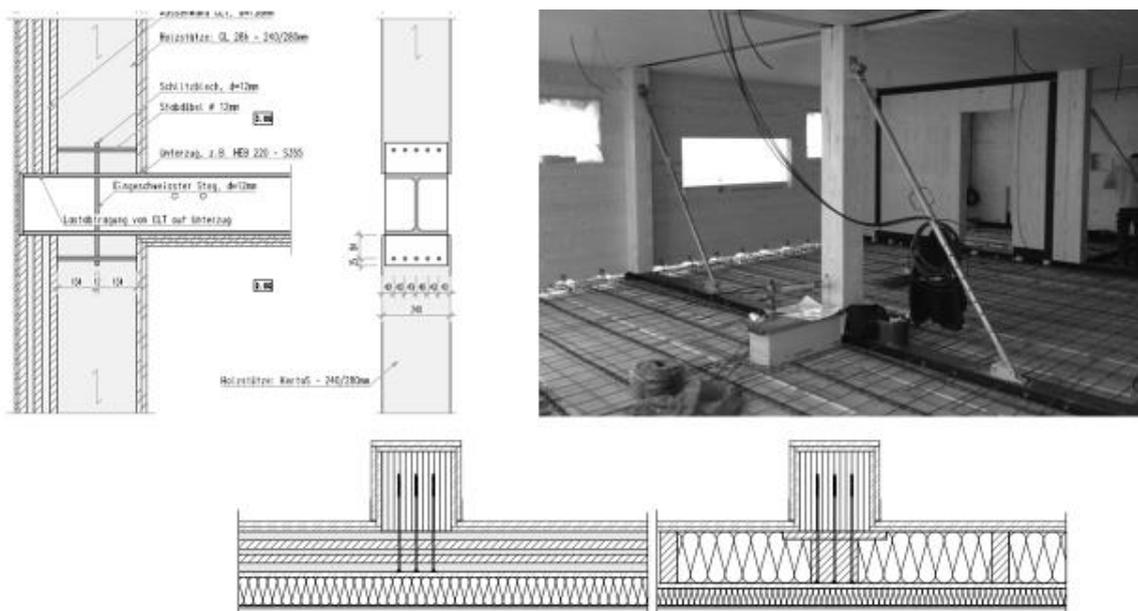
Konstruktionsprinzip beim C13 mit der tragenden Skelettkonstruktion und den nichttragenden Aussenwänden. Rechts eine Bild im Montagezustand.
